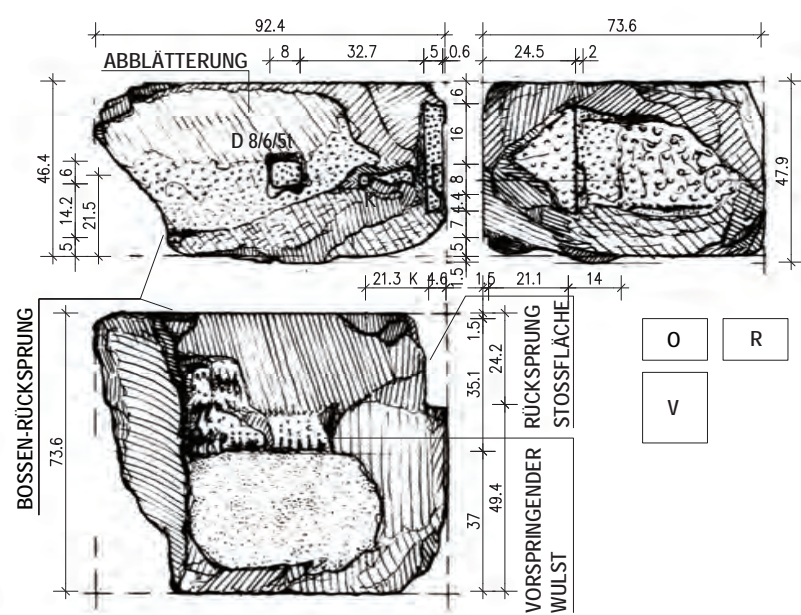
B01/496 Bossenblock der Nordfassade des Obergeschosses mit Gewändeanschluss, M = 1 : 20
